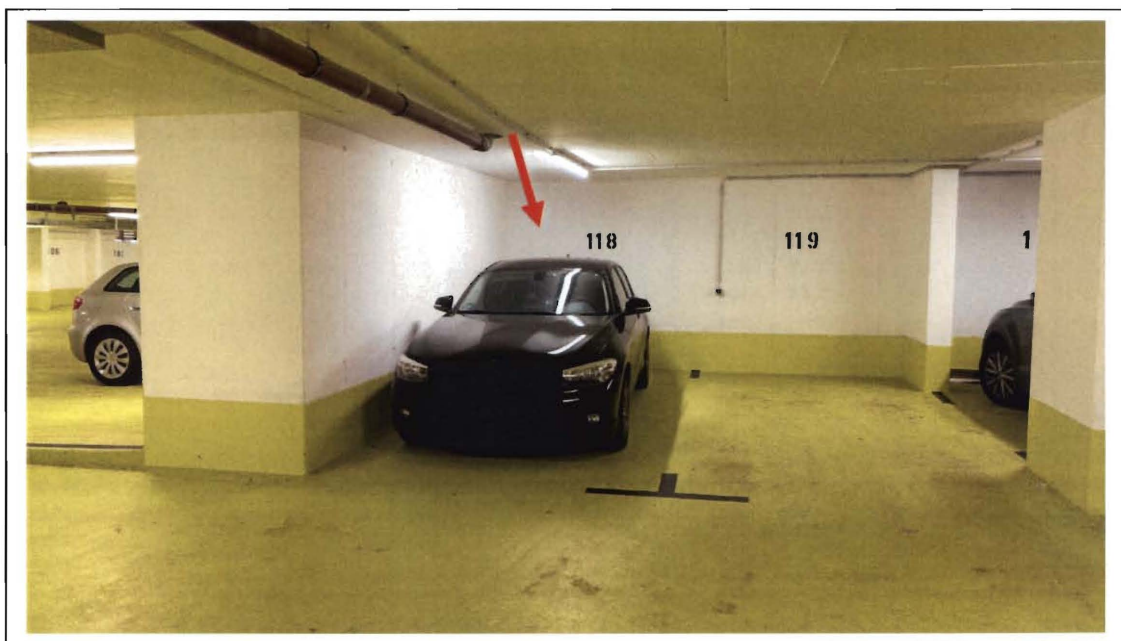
Tiefgarage mit Einzel-Stellplatz Nr. 118
